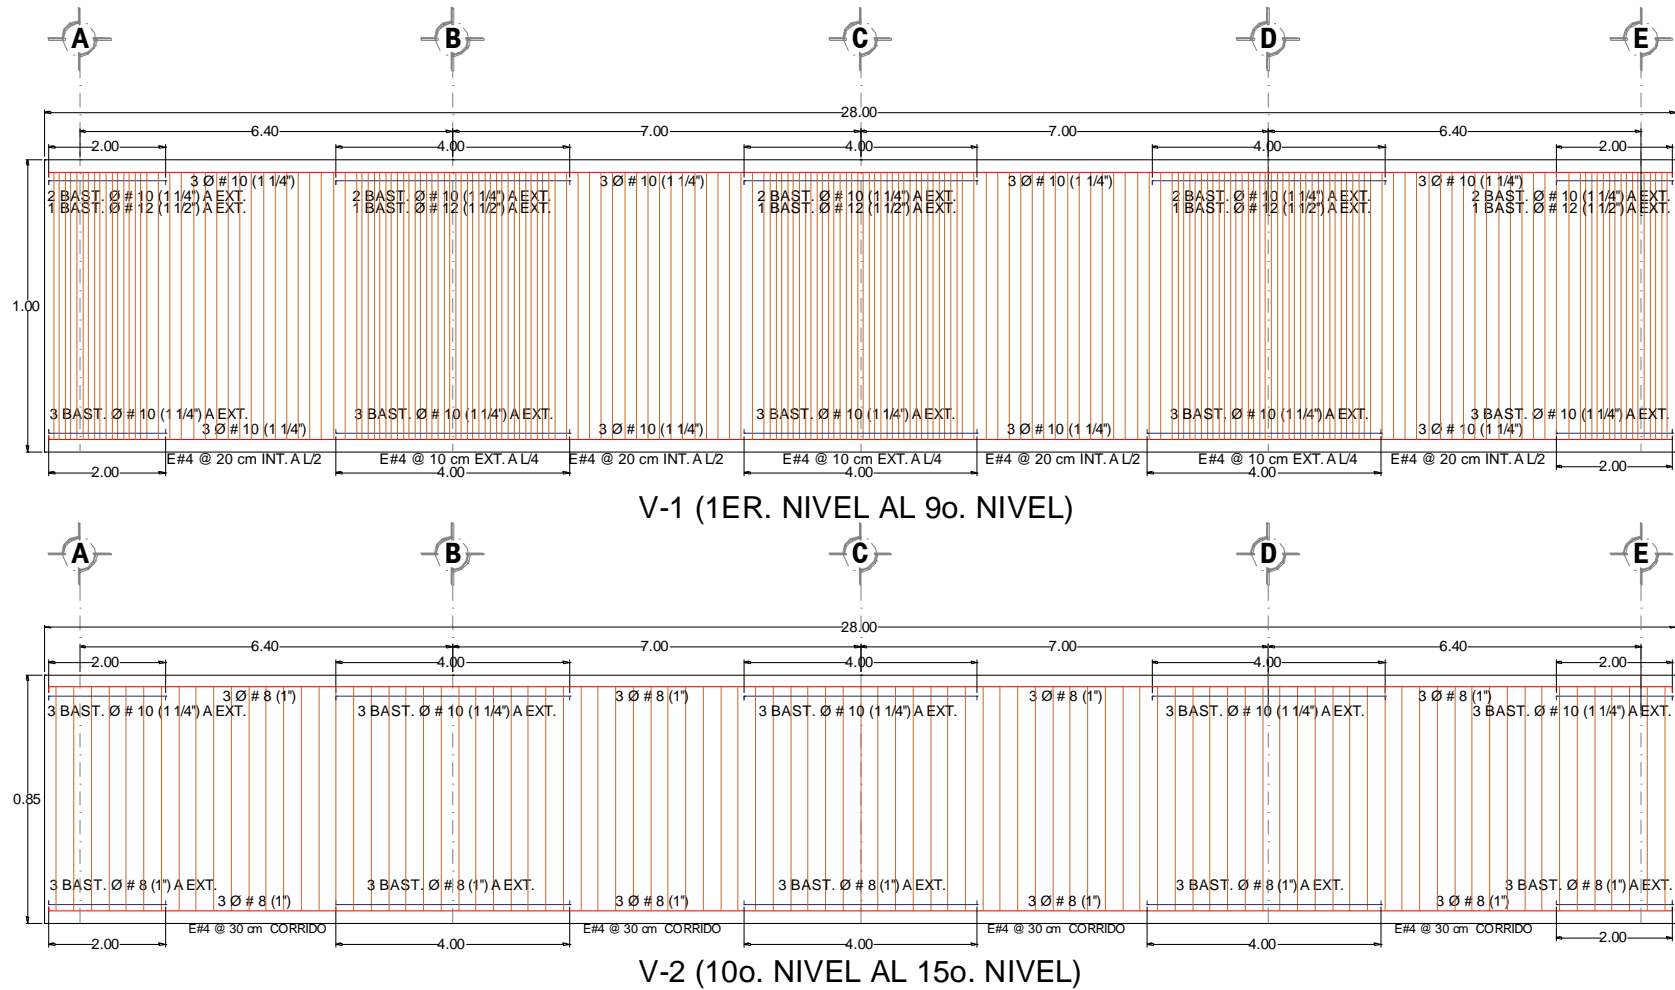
Detallado de armado de vigas del marco de 15 niveles con base a la hipótesis de las NTCC-04.
